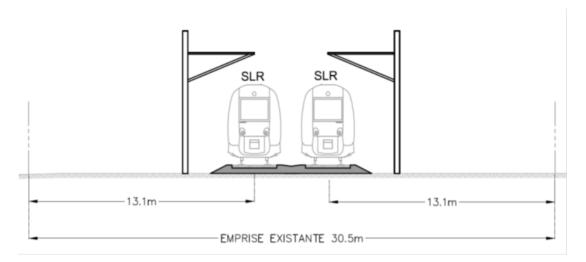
Coupe sur voie ballastée au niveau du sol
